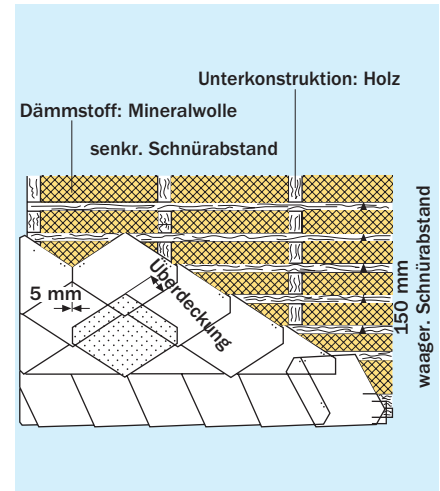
Vorgehängte hinterlüftete Fassaden mit Holz-Unterkonstruktion
